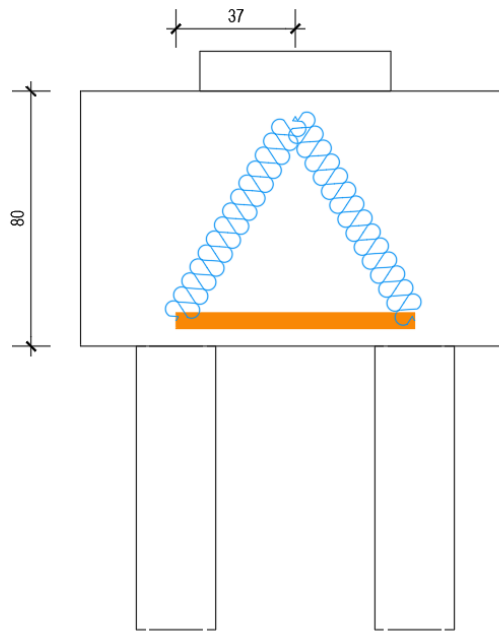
Schema meccanismo tirante-puntone fondazione spalla
